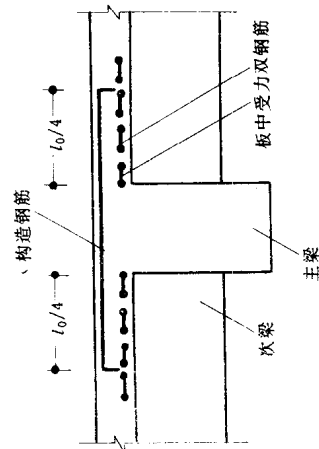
板中与梁肋垂直的构造钢筋配置
